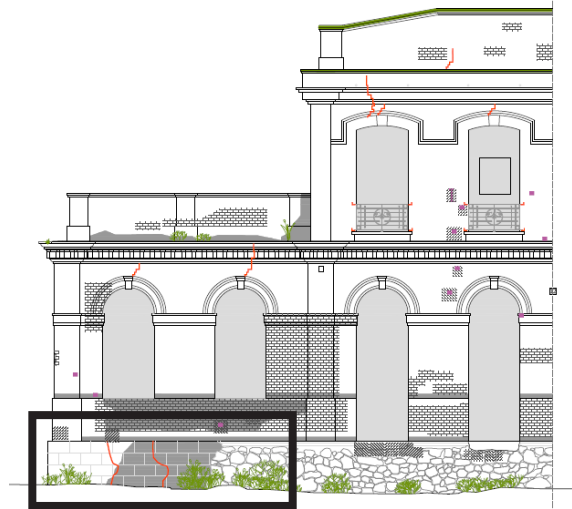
Desprendimiento mortero de recubrimiento y de las juntas en la fábrica de mampostería ordinaria de cimentación en la Fachada Este (principal, c/ Mayor de Nazaret). Fuente: Propia
